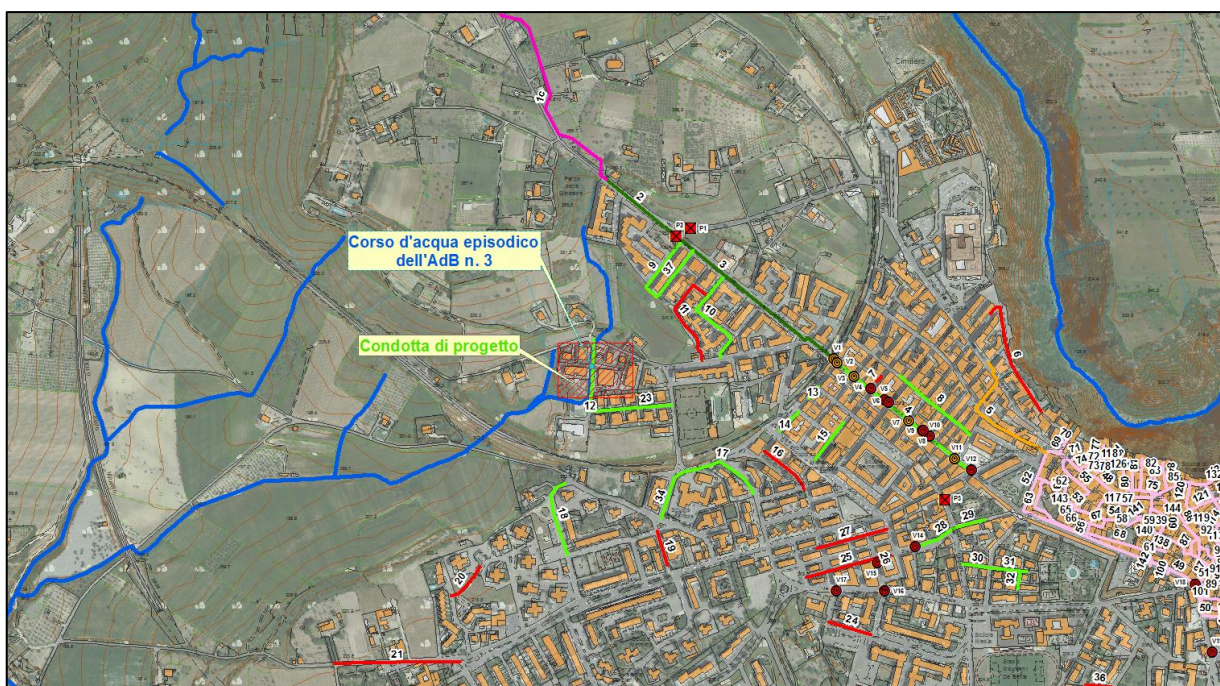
Stralcio planimetrico con individuazione dell'interferenza dell'intervento ID12 con il Corso d'acqua episodico n.3 dell'AdB
